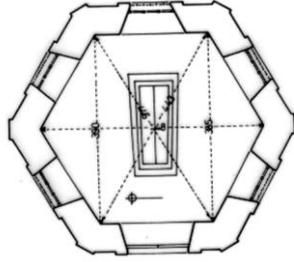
مسقط أفقي لتربة شاهزادة محمود في
